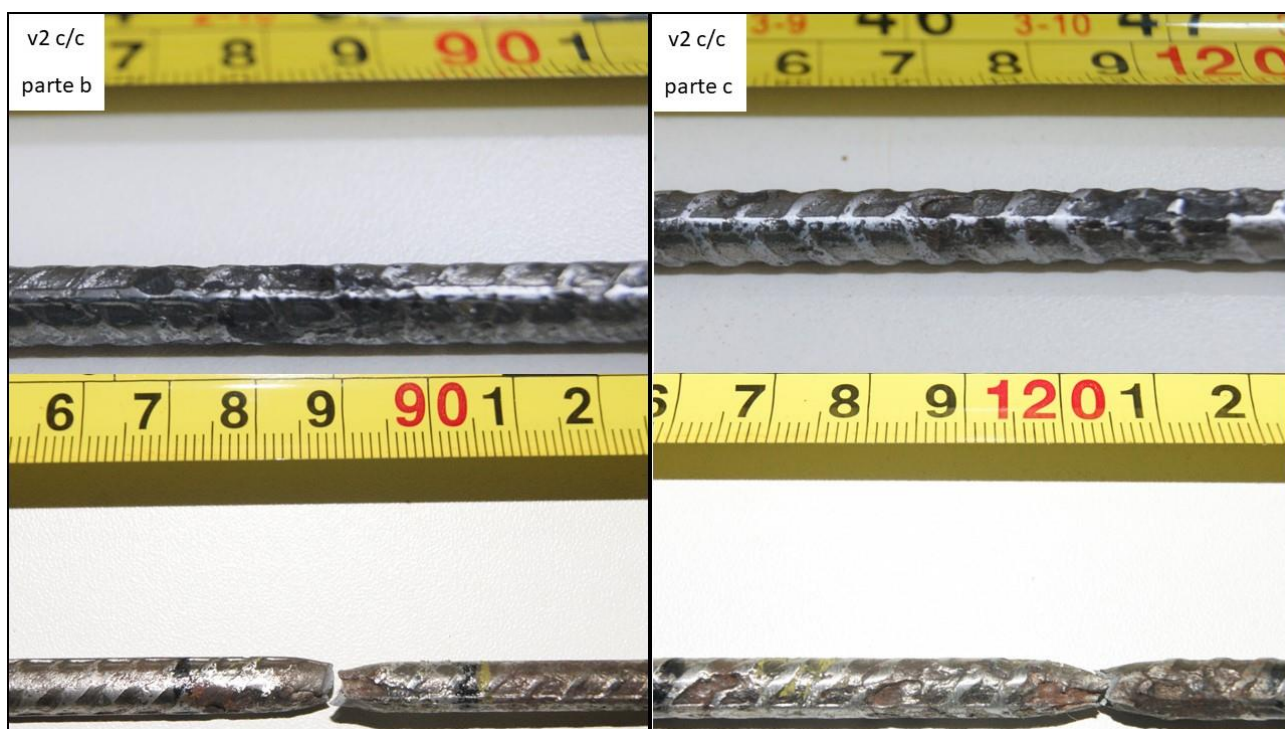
Pontos dos pites e de ruptura no ensaio de tração das barras da viga vc 2 c/c
